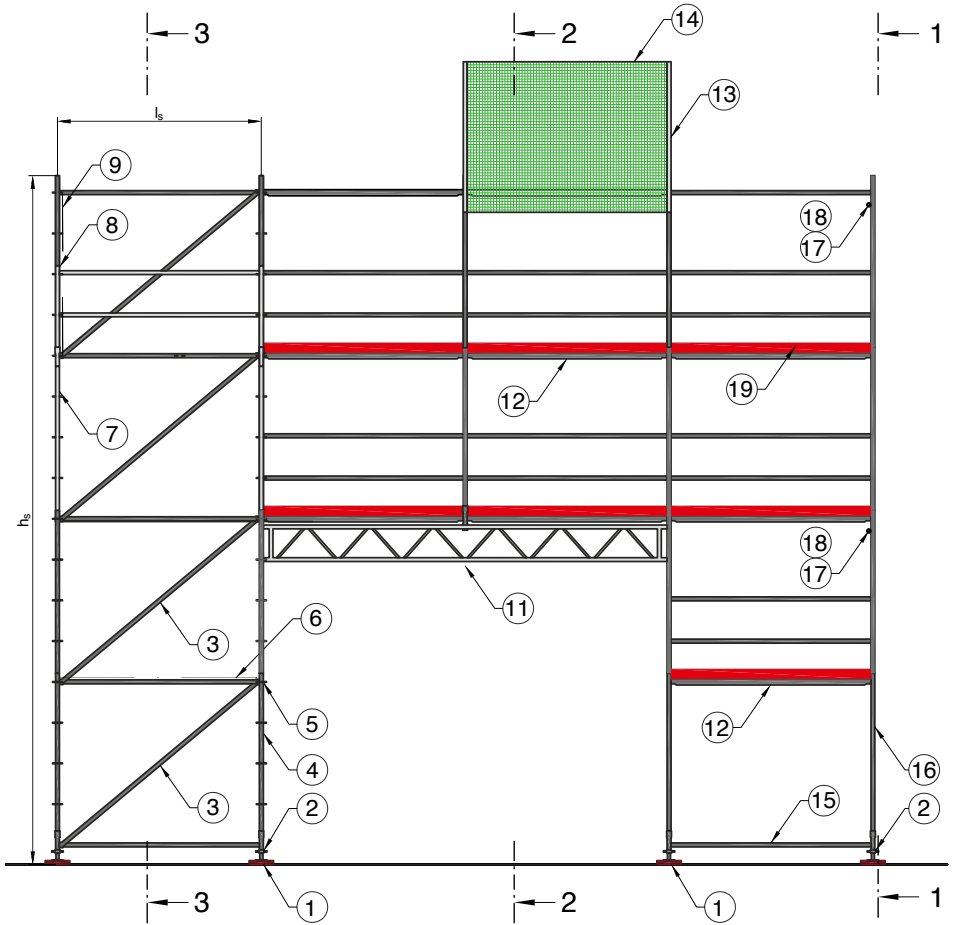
Bauteile eines Systemgerüsts und deren Benennung
